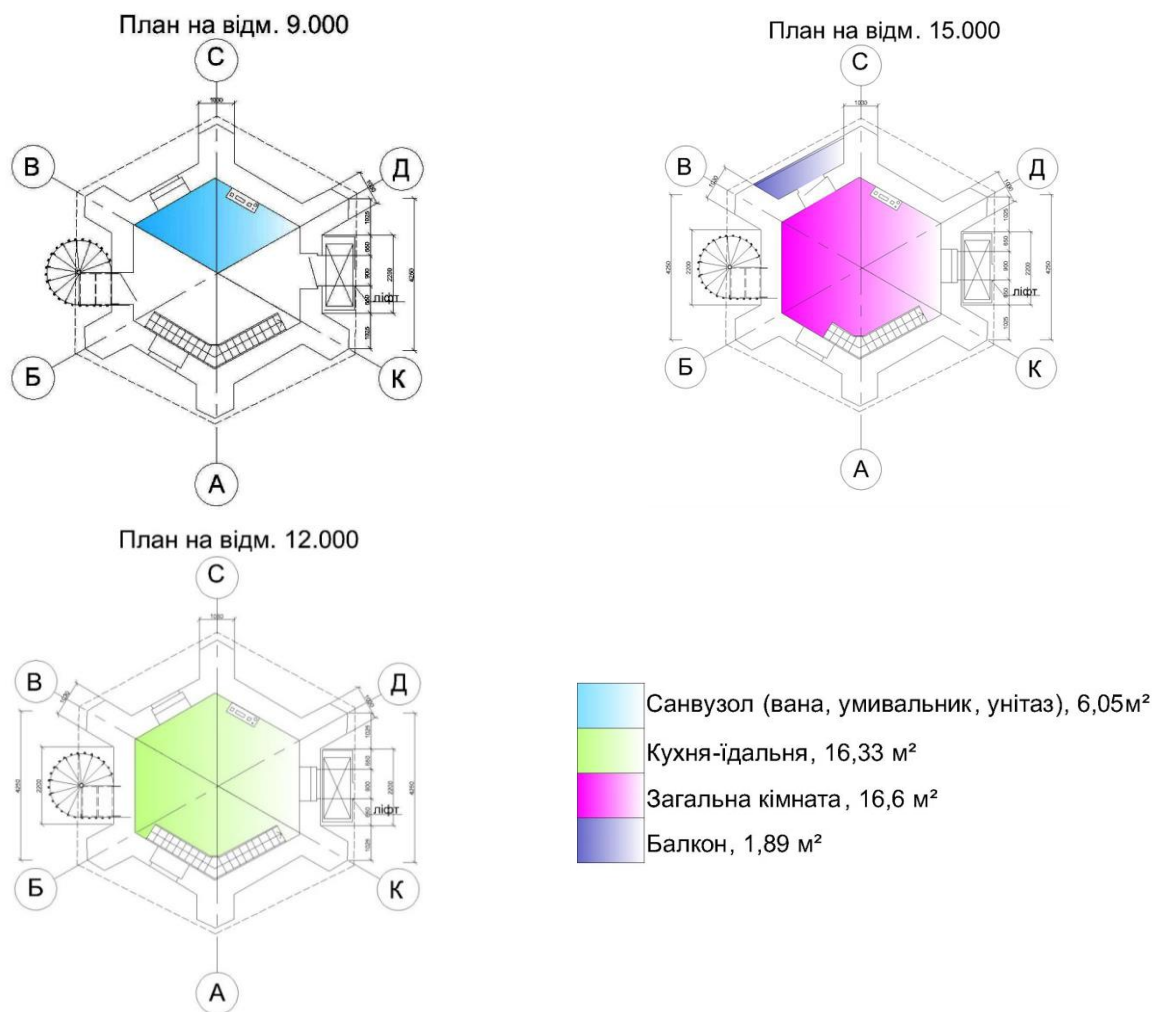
Проектні пропозиції планувального рішення першого, другого, третього поверхів 2-ої квартири
